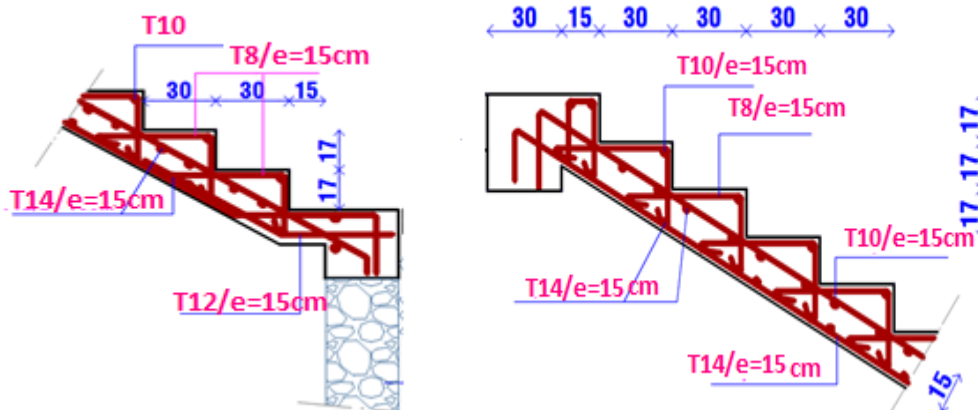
Coupe ferrailage escaliers supérieur et inférieur
